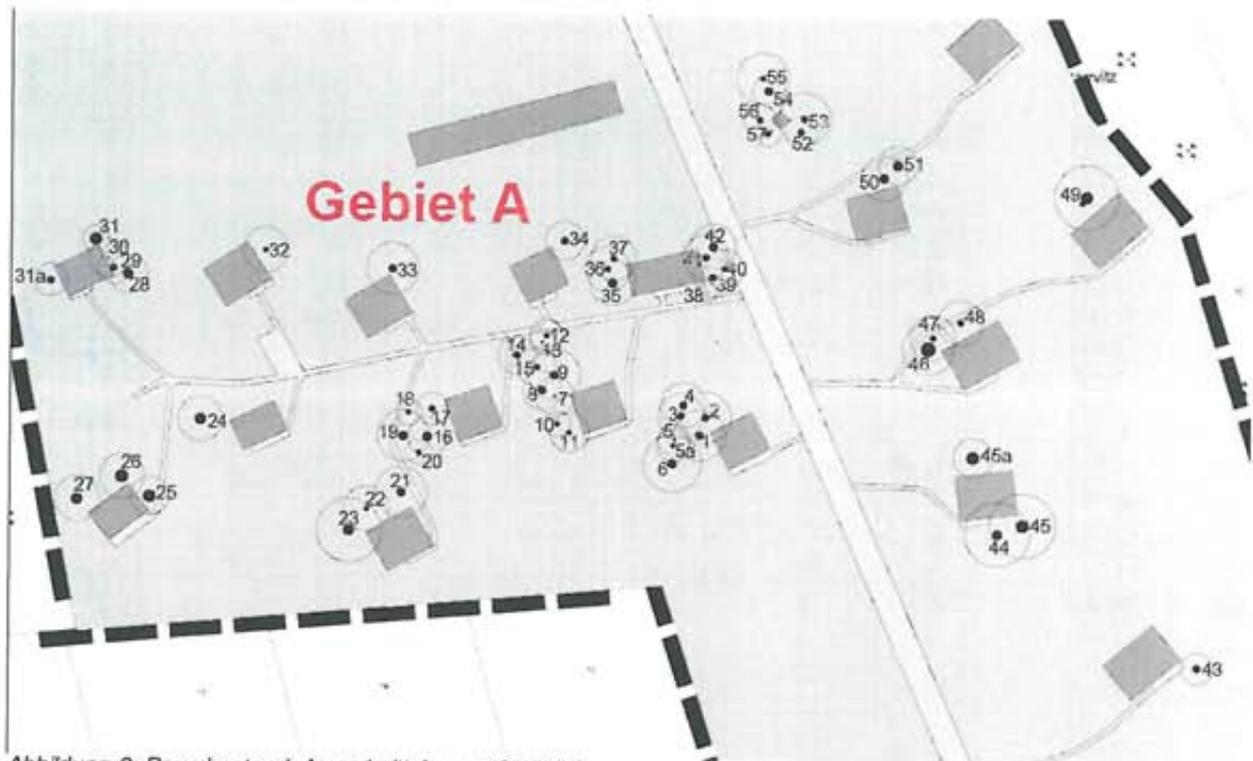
Baumbestand, Ausschnitt A unmaßstäblich
